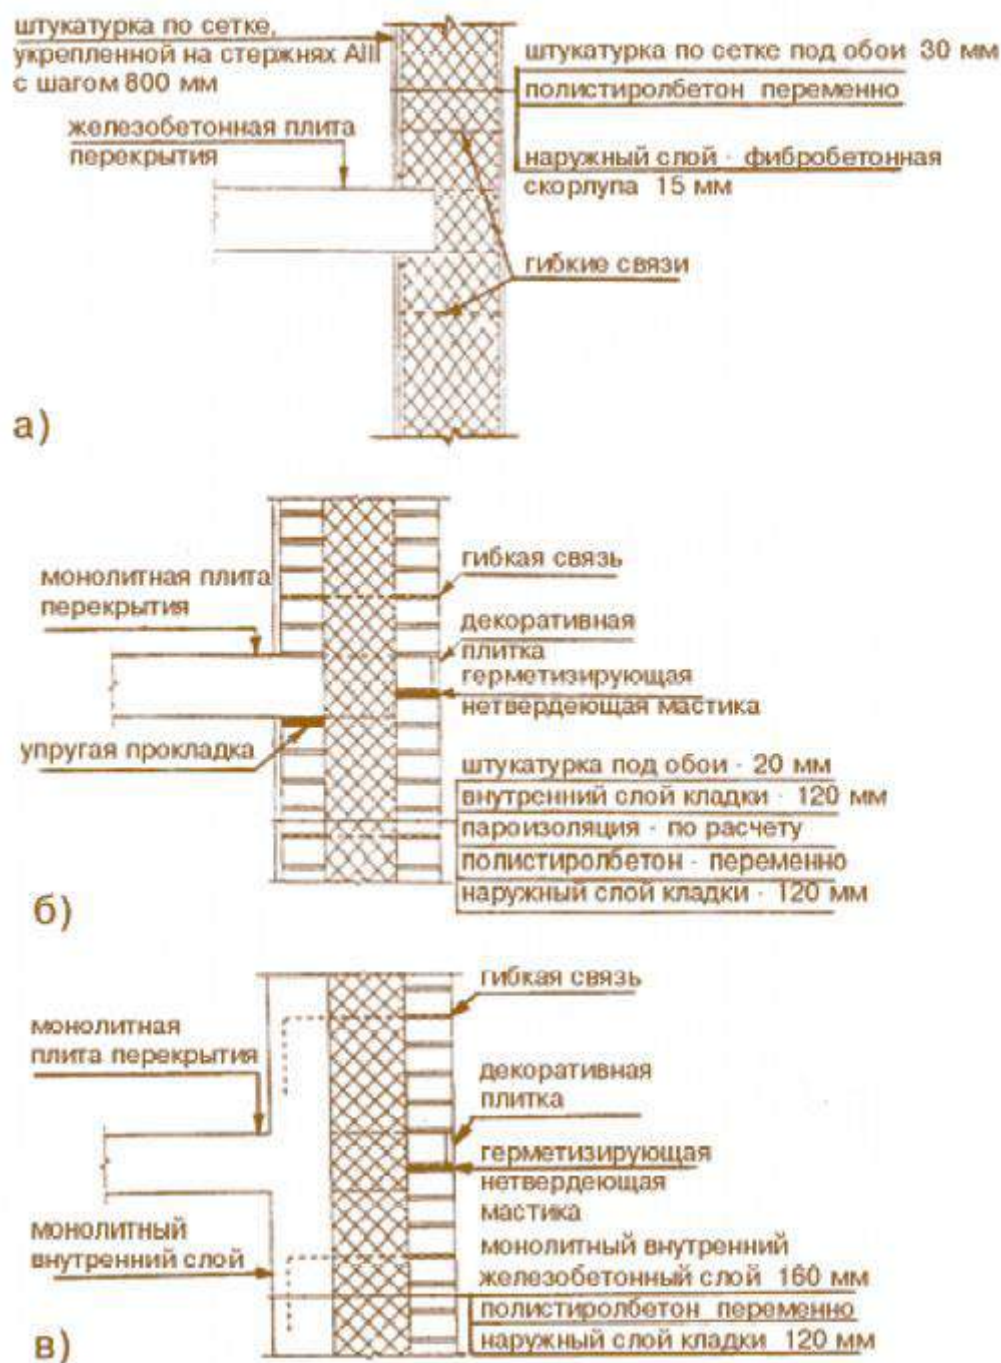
Технические решения наружных стен зданий с использованием монолитного теплоизоляционного полистиролбетона (продольные разрезы): а, б – навесная стена; в – несущая стена
